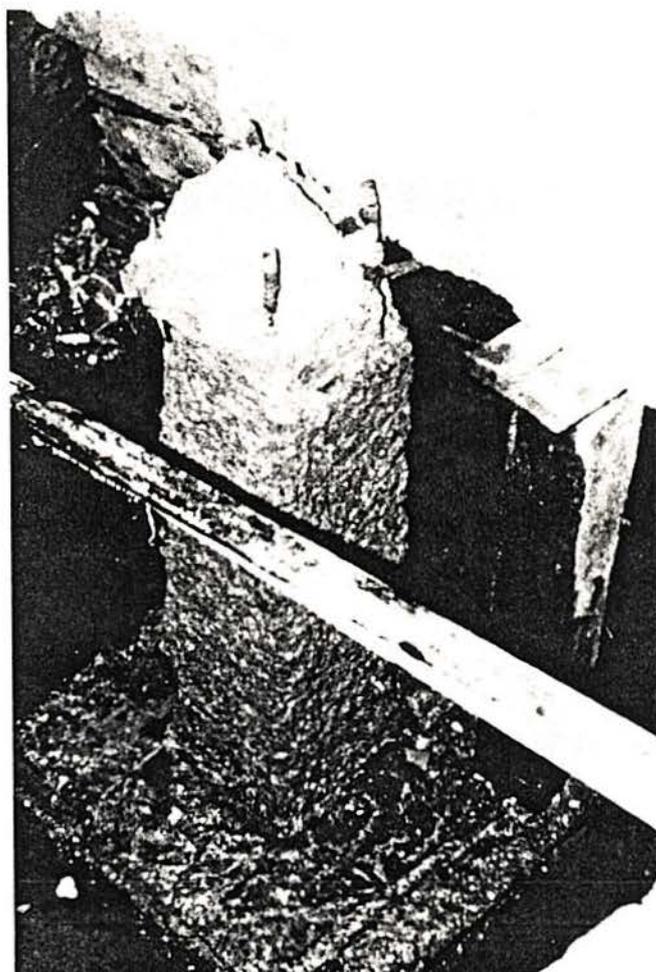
Vista de bloco e pilarete de fundação deslocados em relação ao eixo do cintamento. Para repor as condições de projeto procedeu-se o encamisamento do pilarete com concreto convencional
